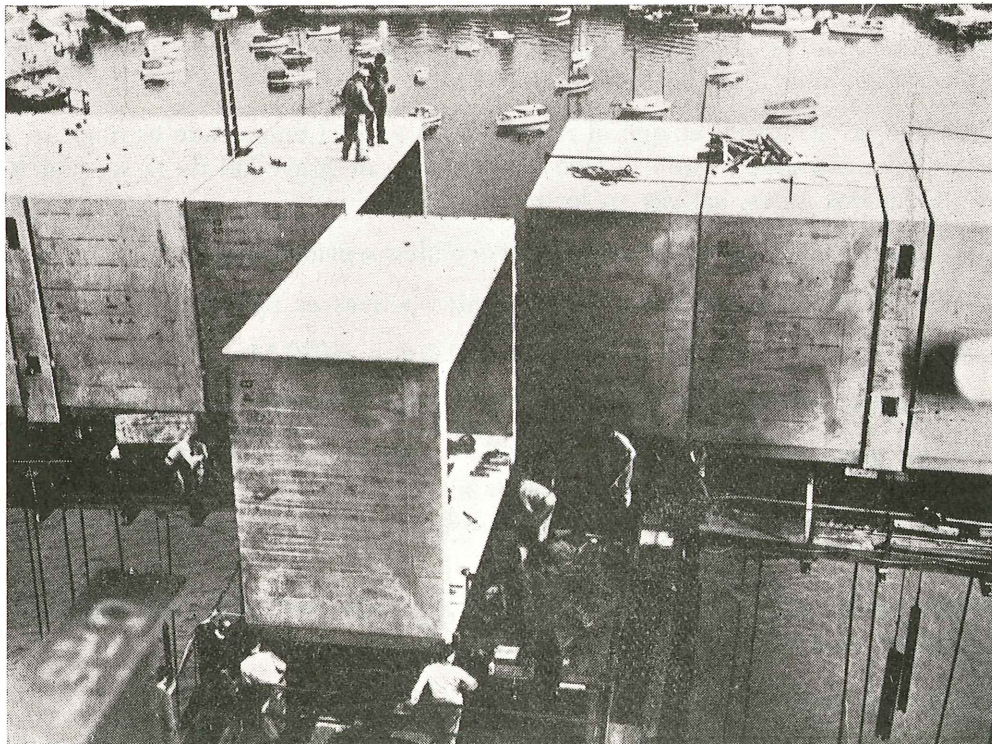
Dovela en la clave, colocada por una vagoneta que circula sobre la torre central.
